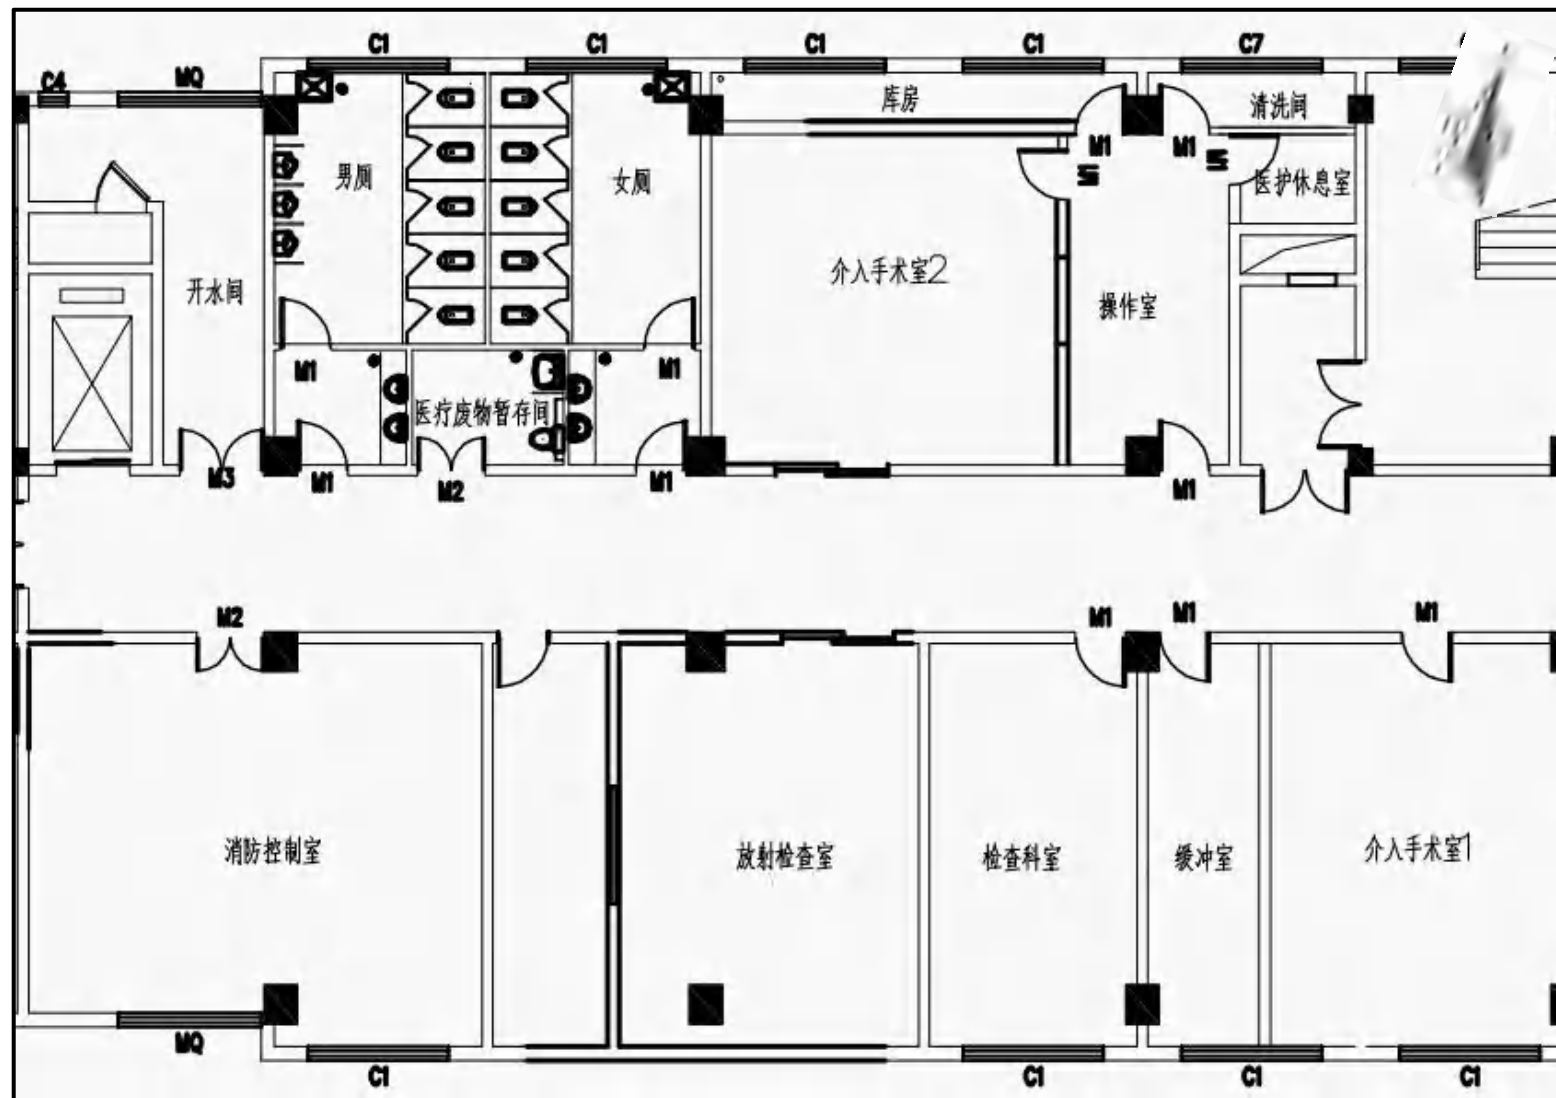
本项目改造后介入手术室 2 周边平面布局图
